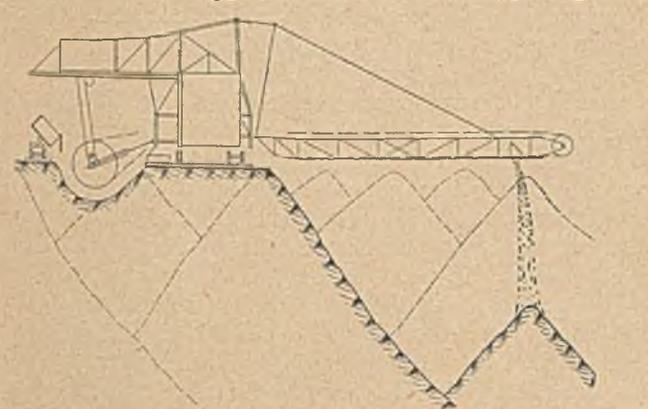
Kippe mit Abraumförderer der Maschinenfabrik Buckau.
